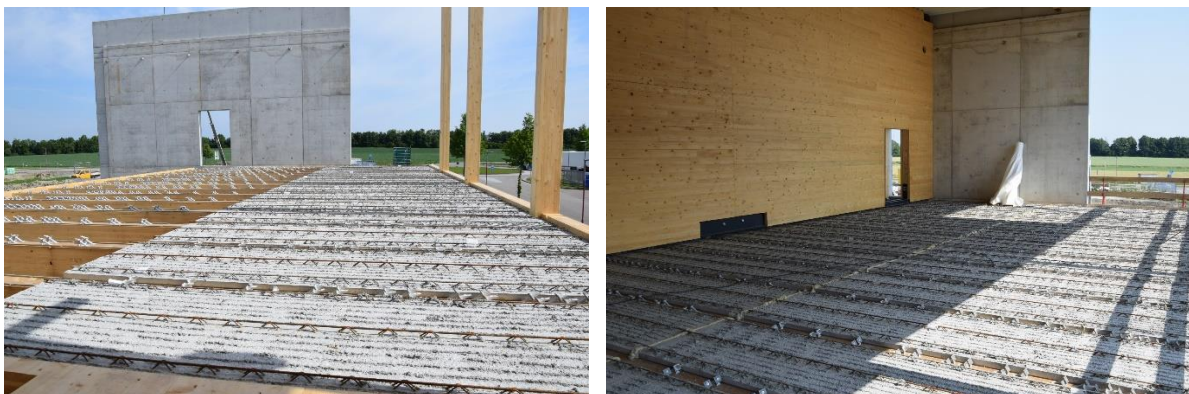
HBV-Decke im Montagezustand vor dem betonieren.
